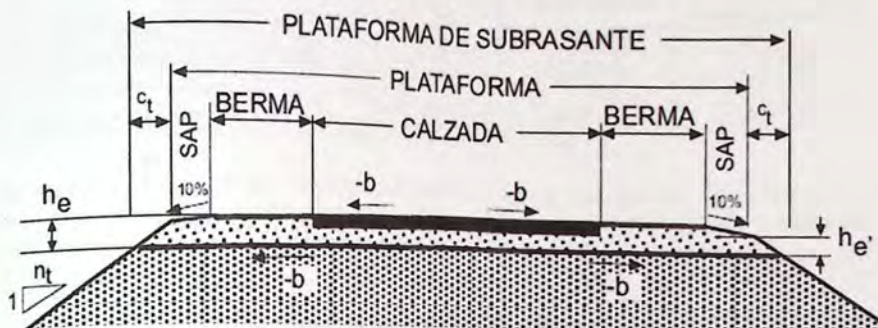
Perfil tipo pavimento flexible. [13]
